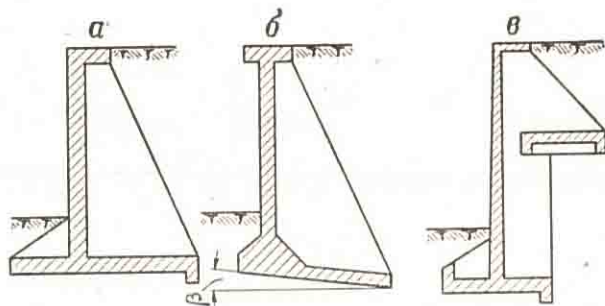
Железобетонная угловая подпорная стенка с ребрами:
